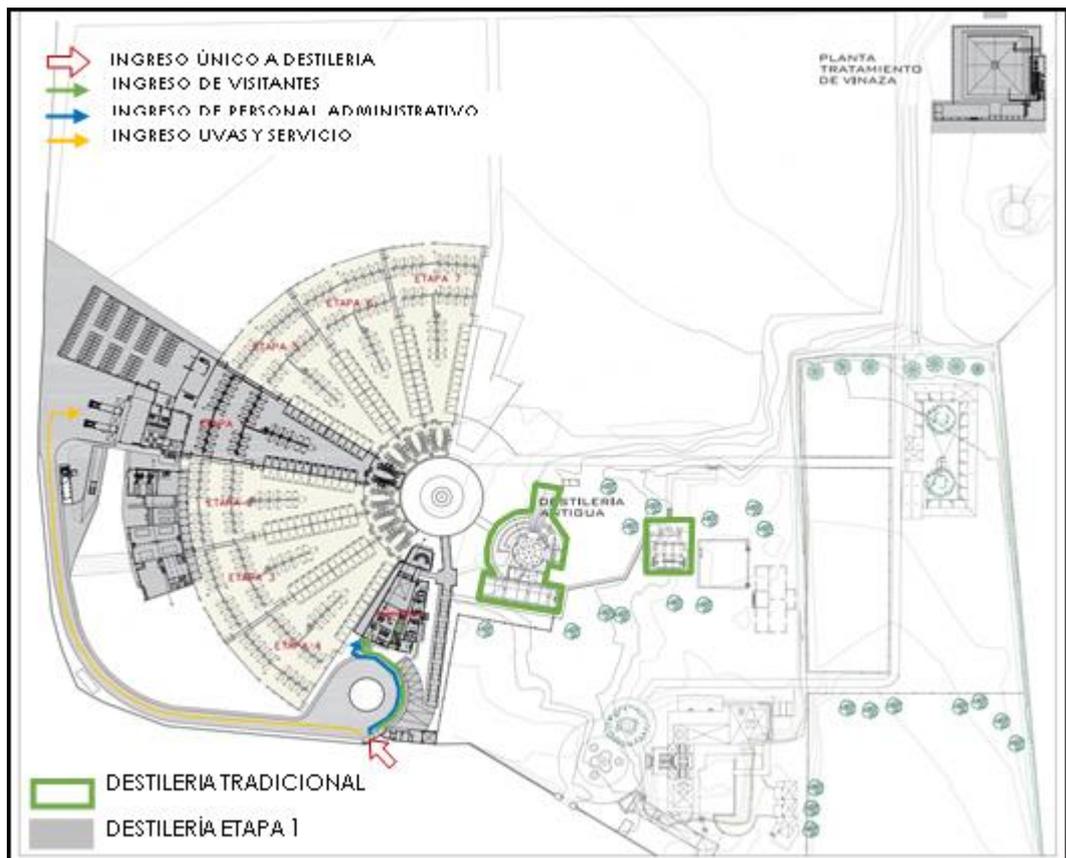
Planta de primer nivel – Esquema de circulación - Ilustración: Arquitectura Panamericana –
